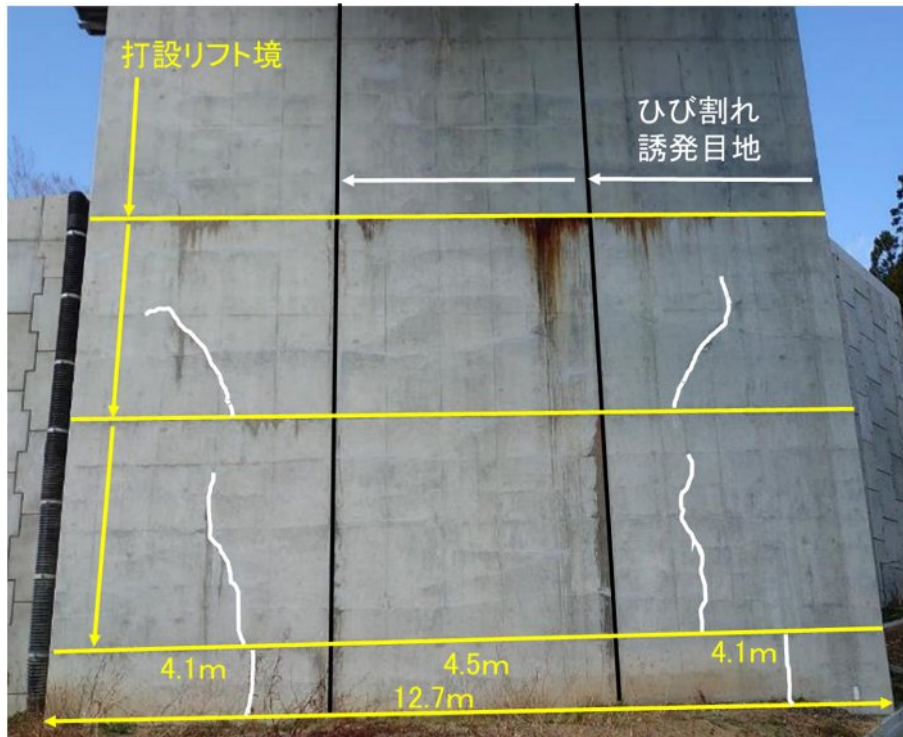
外部拘束温度ひび割れ
